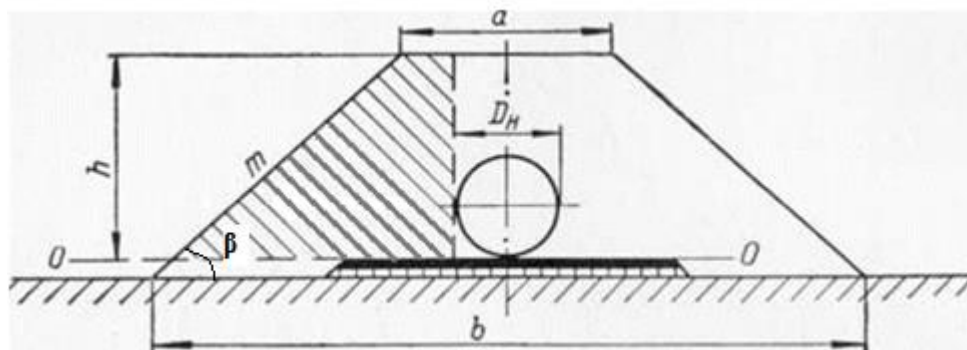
Параметры насыпи и трубопровода: $D_{\text{н}}$ – диаметр трубопровода равен 1020 мм; a – верхнее основание трапеции насыпи равно 1,7 м; h – высота трапеции равна 2,2 м; b – основание трапеции насыпи; m – заложение откосов
